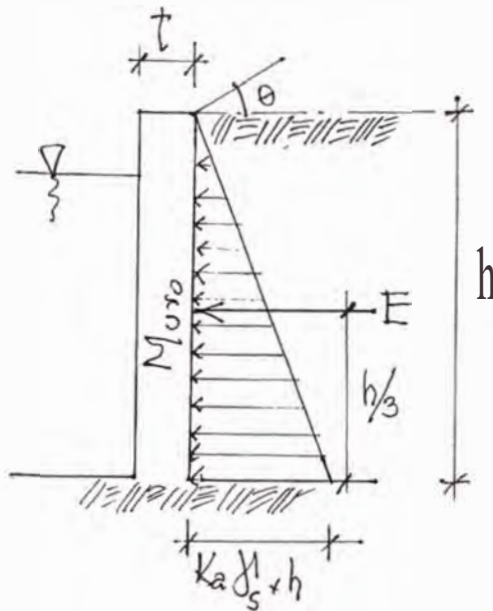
Muro soportado por fuerzas de empuje(E)
